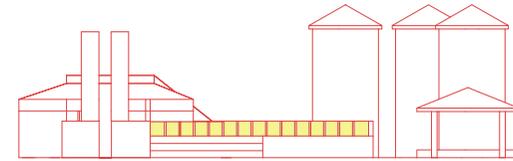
, Alzados de las zonas abiertas al exterior.
